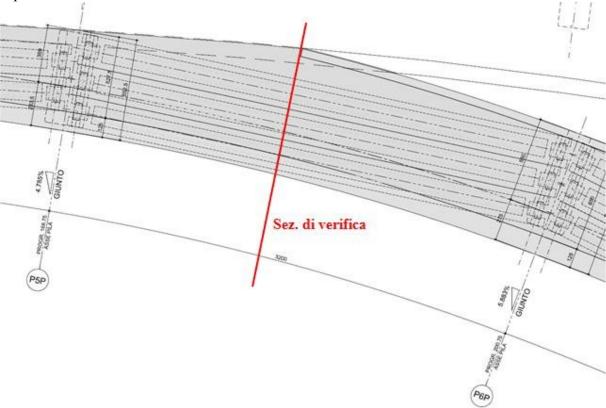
Vista planimetrica rampa P – Sezione di verifica soletta F3
